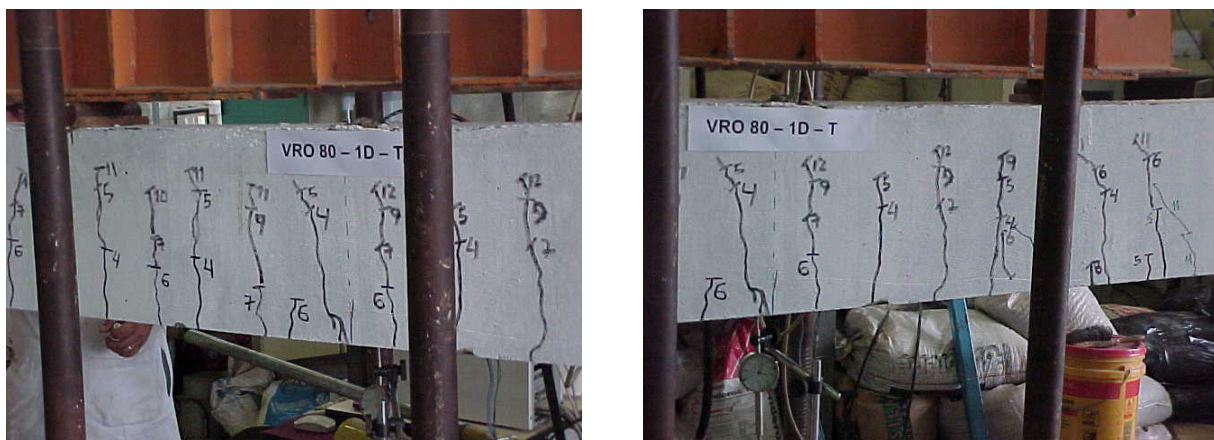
Vista lateral da viga de referência VRO80-1D-T com o mapa das fissuras, após a realização do ensaio.
